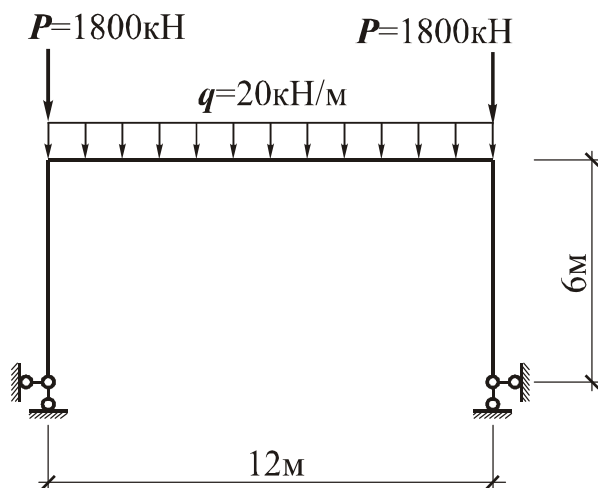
Расчетная схема двухшарнирной железобетонной рамы
